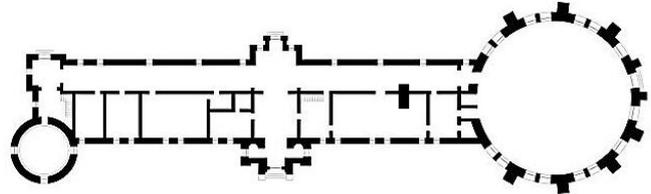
Planta esquemática de observatorio con gran telescopio.
